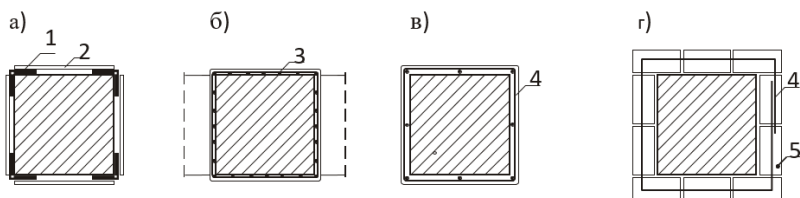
Усиление каменных простенков с помощью стальных обоек (а), армированных бетонных либо штукатурных обоек (б), поперечного армирования (в) и каменной кладки (в): 1 – стальные уголки, 2 – поперечные накладки, 3 – железобетонная обойма, 4 – поперечные армирующие стержни, располагаемые в горизонтальных швах кладки, 5 – новая каменная кладка.
